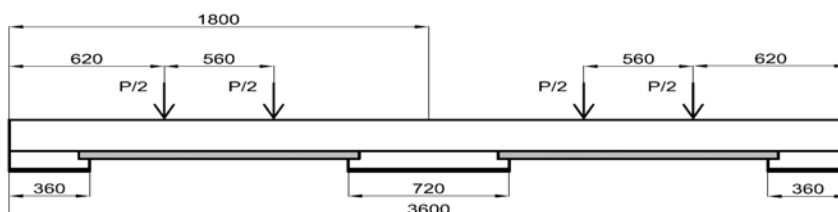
Схема випробування залізобетонних плит незнімної опалубки ПМ-1,2,3.
